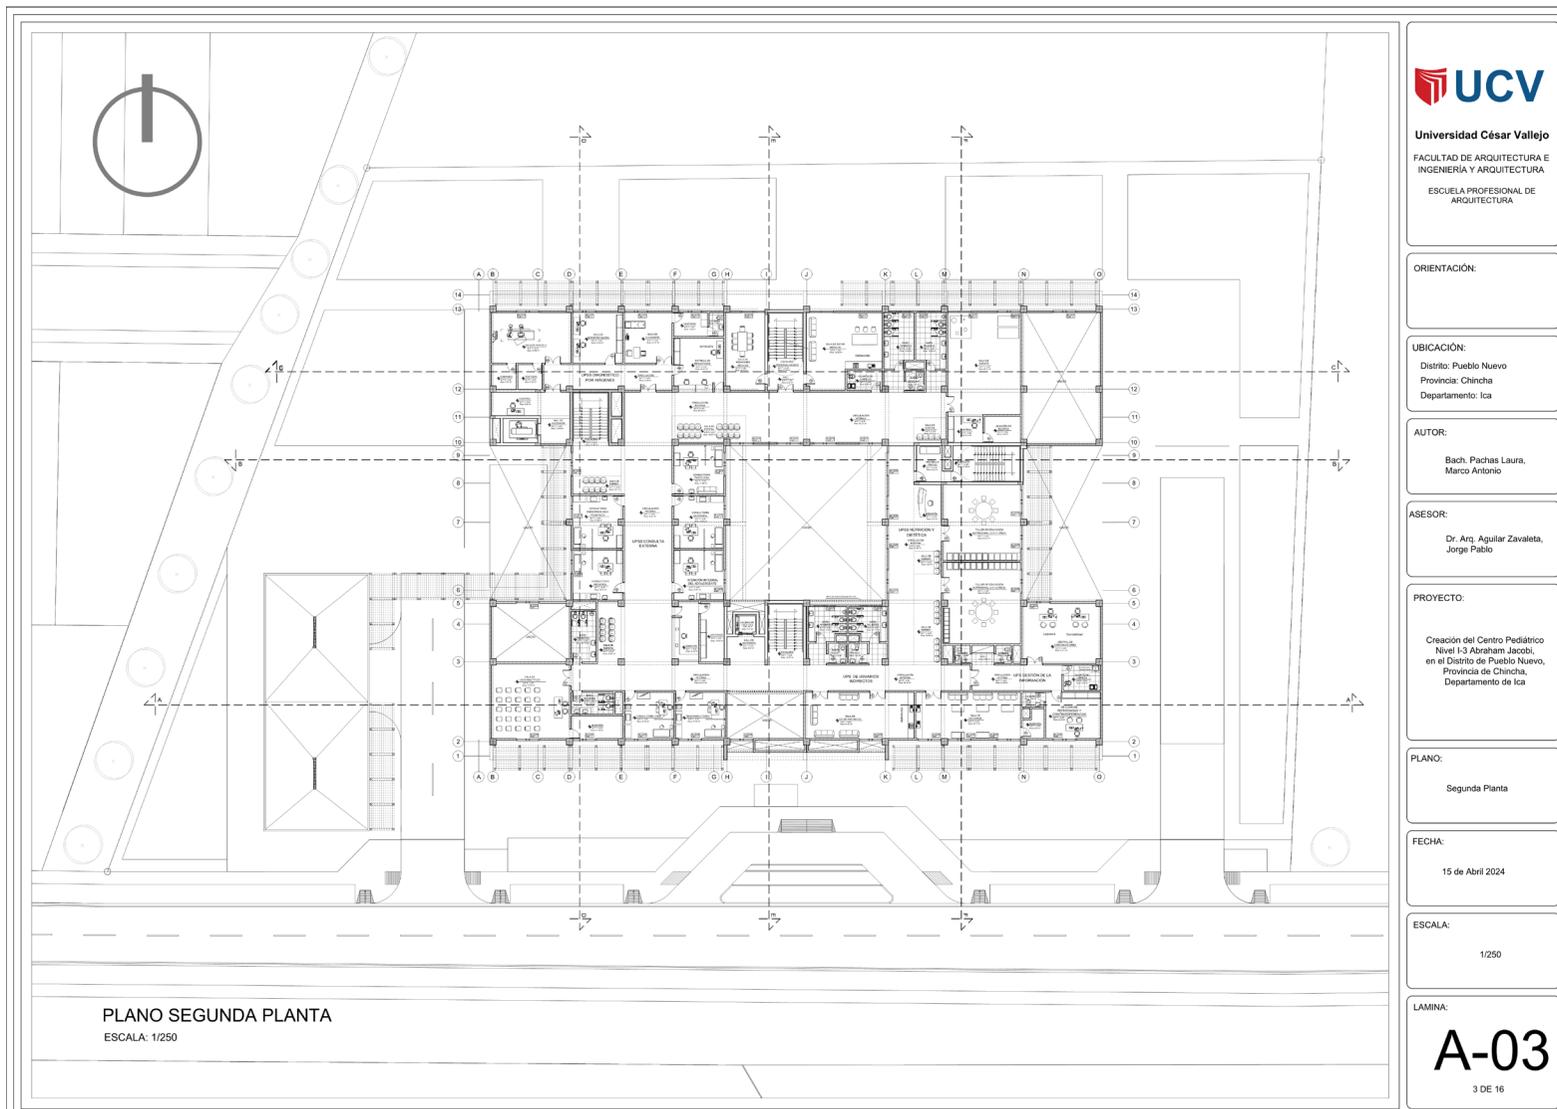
A-03 Plano segunda planta. Fuente: Elaboración propia.
